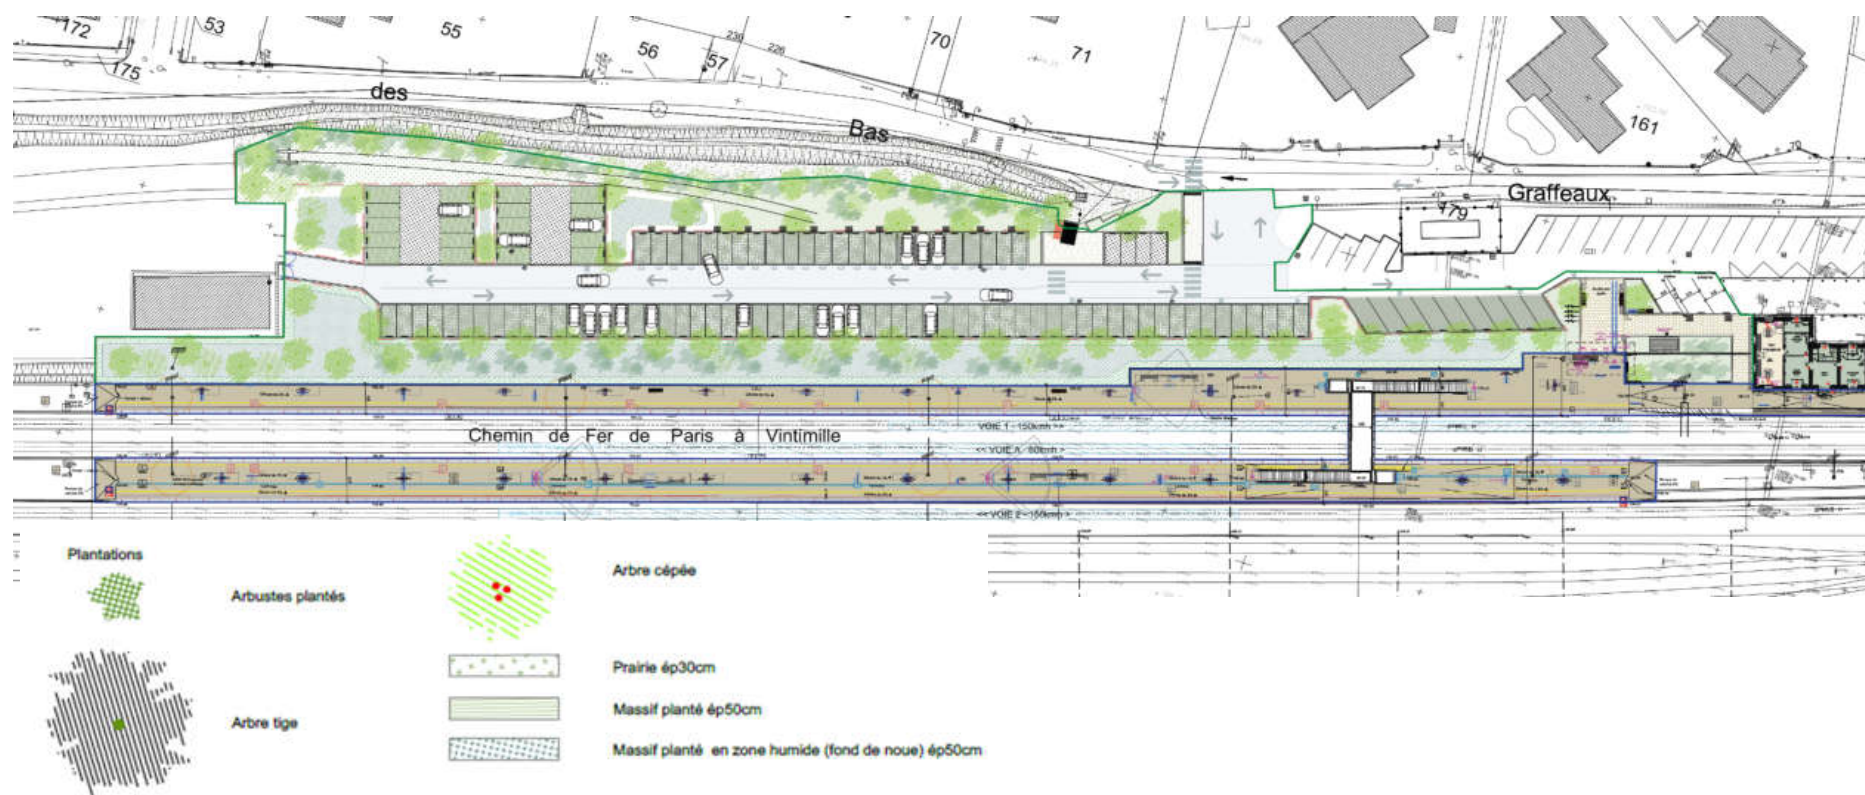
vue en plan de la gare de Carnoules (AREP, APD – 2025)
